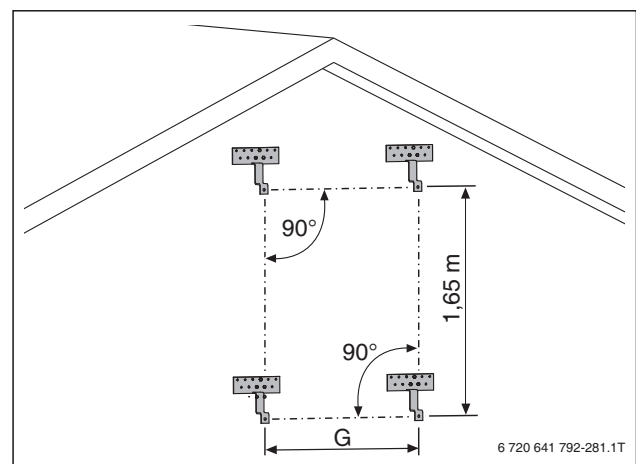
Positionen der Haltebügel bei Verwendung des Aufdachmontage-Sets für einen SKT12 oder SKR6 (SKR6: G=450 mm; SKR12: G=800 mm)
